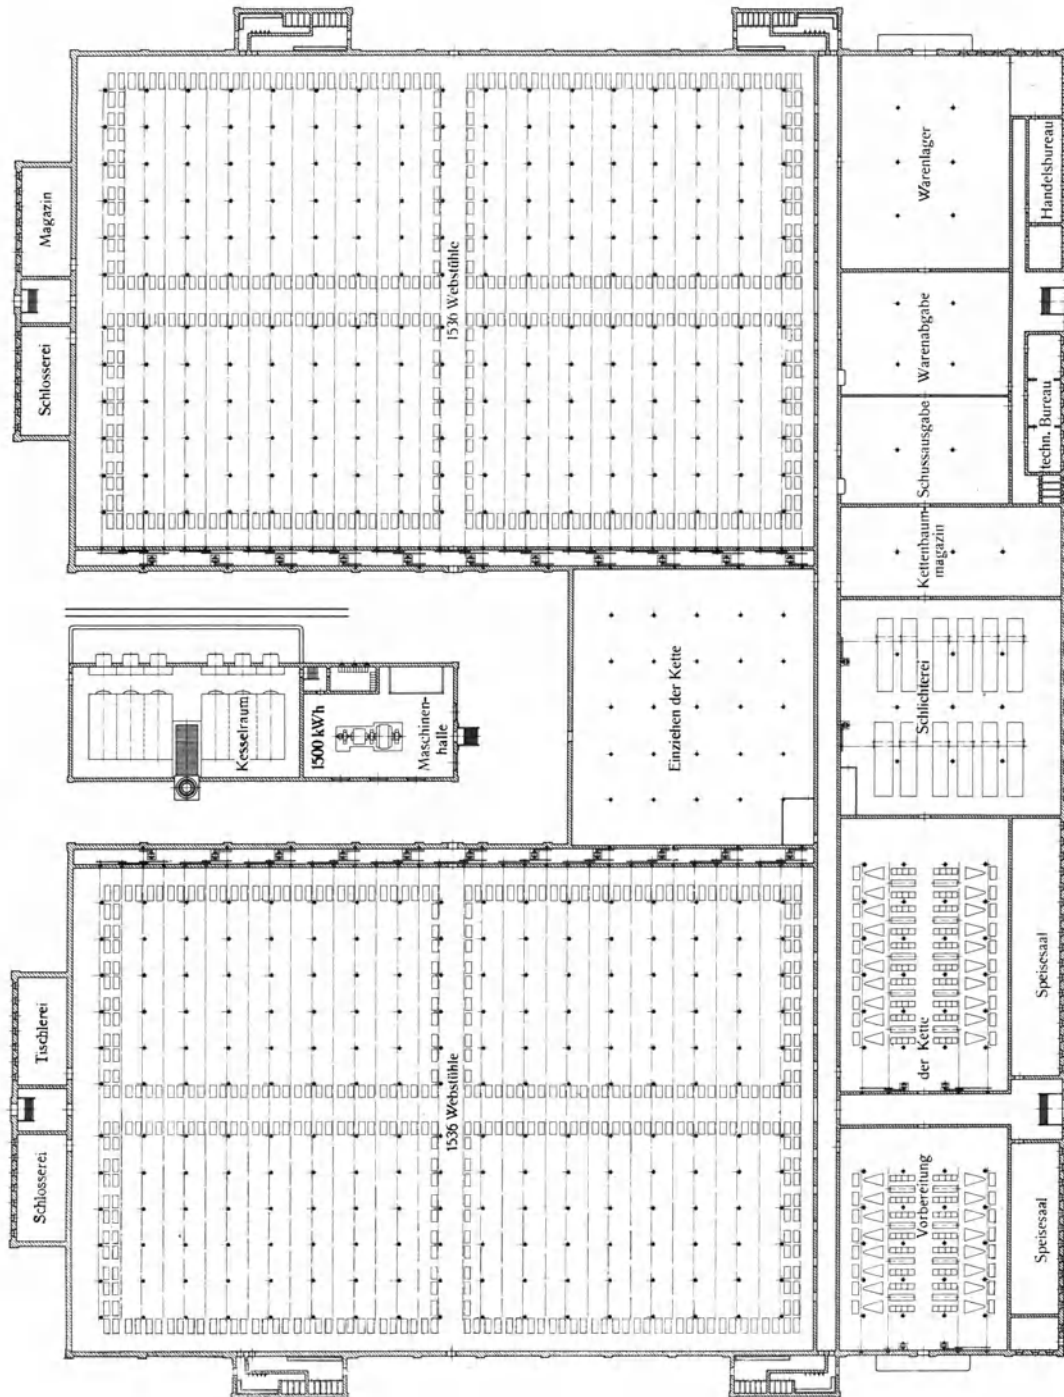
Plan der Baumwollweberei für 3000 Stühle (mit elektr. Antrieb).
